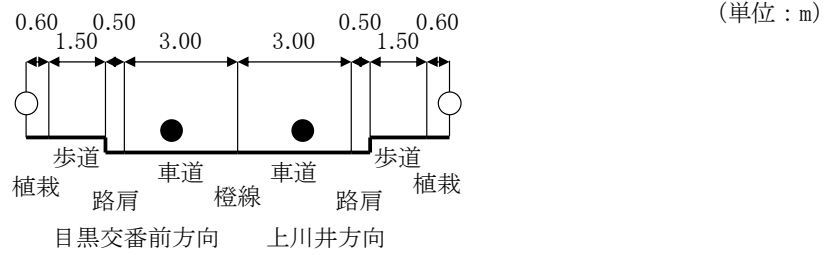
(3) 道路断面及び排出源の位置 (No. 3)
